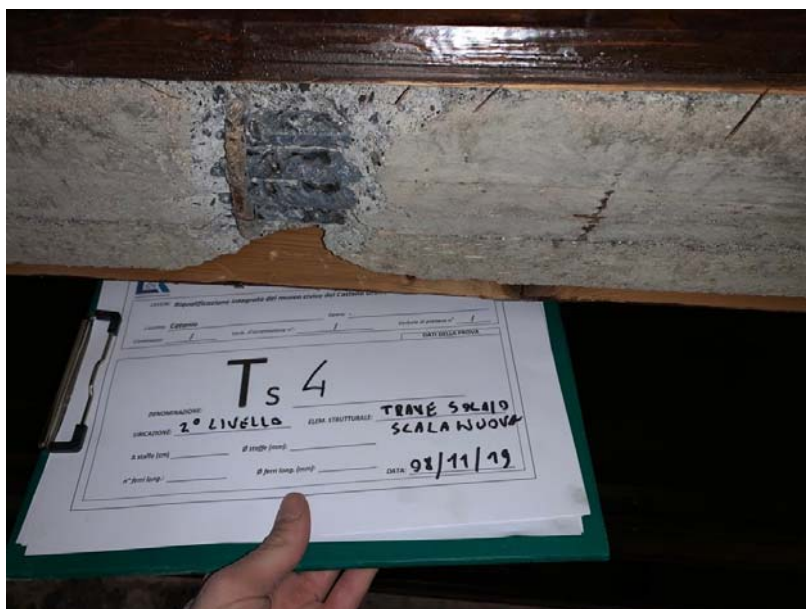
Traccia strutturale trave - 2° Livello quota +6.10 m
